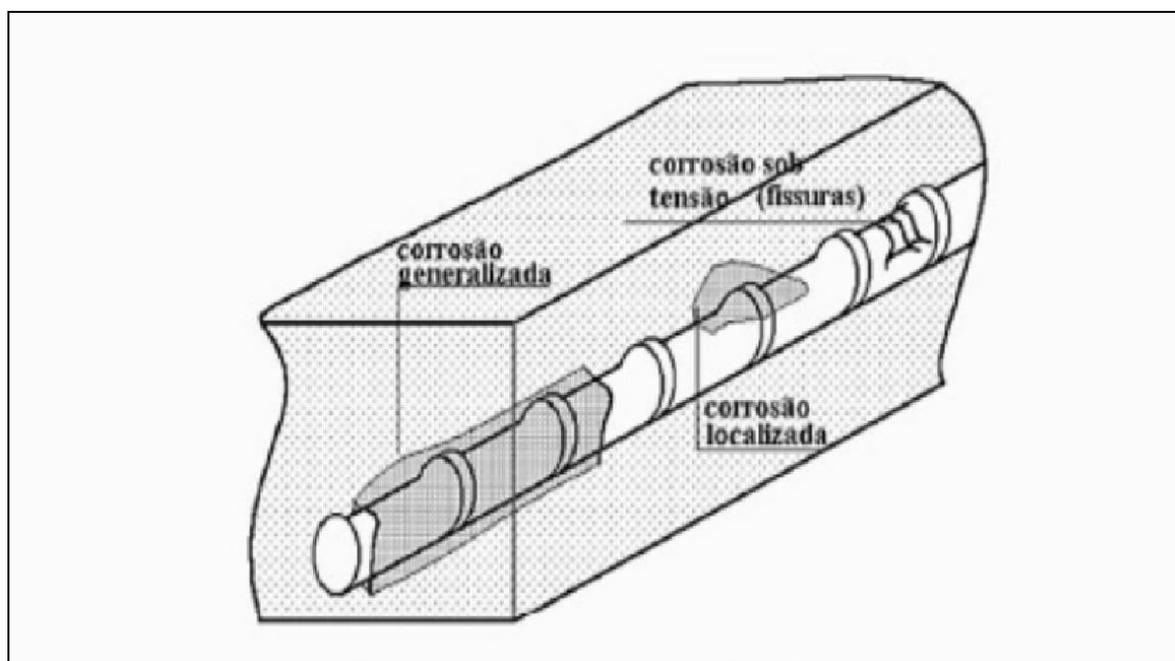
Tipos de corrosão do aço no concreto armado
